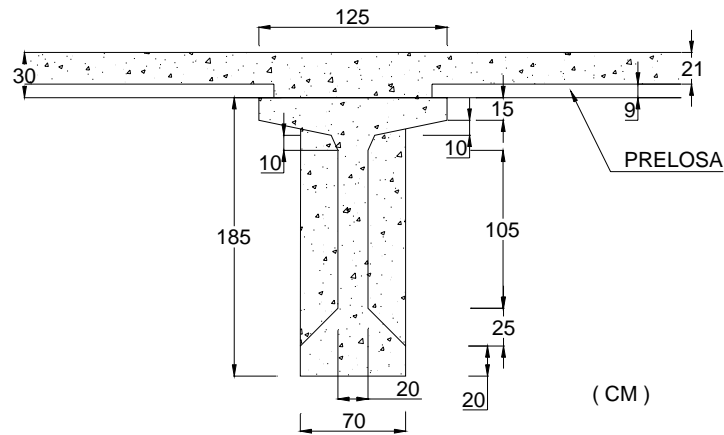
Sección en I de las vigas que soportan la losa de la superestructura.
